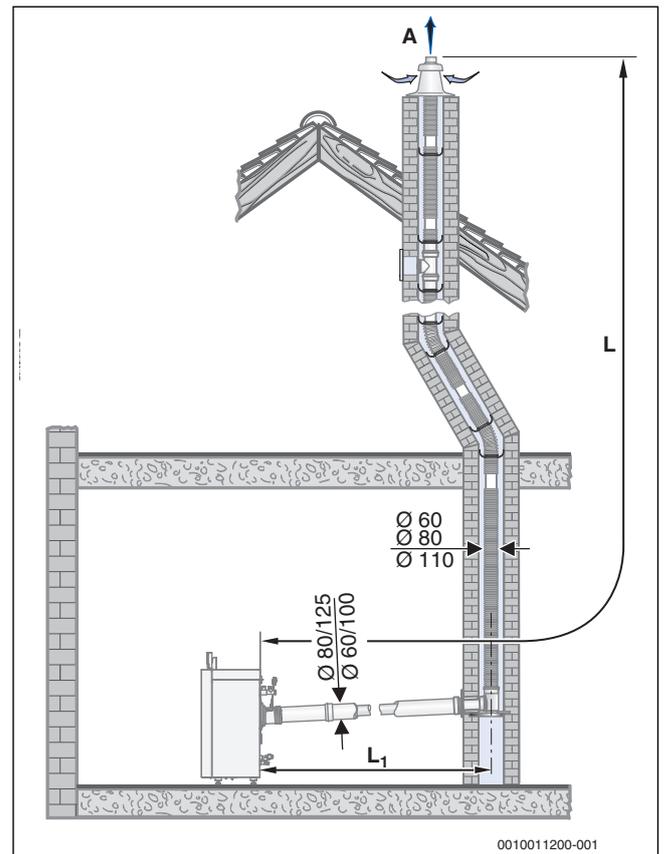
Montagevarianten mit dem Bausatz GA-K + ÜB-Flex
